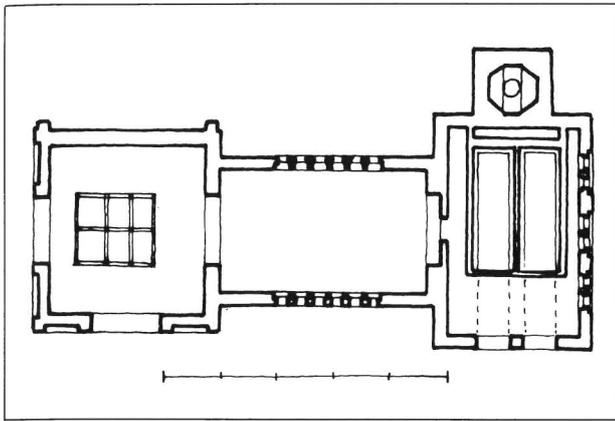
Grube Apfelbaumer Zug: Aufnahme des Grundrisses im letzten Bauzustand vor dem Abbruch der Baulichkeiten
